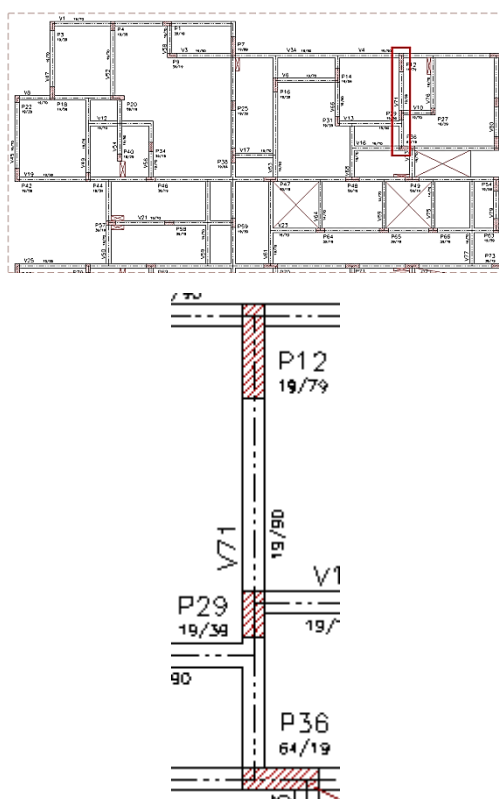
Edifício Vita Belle: localização da viga V71
